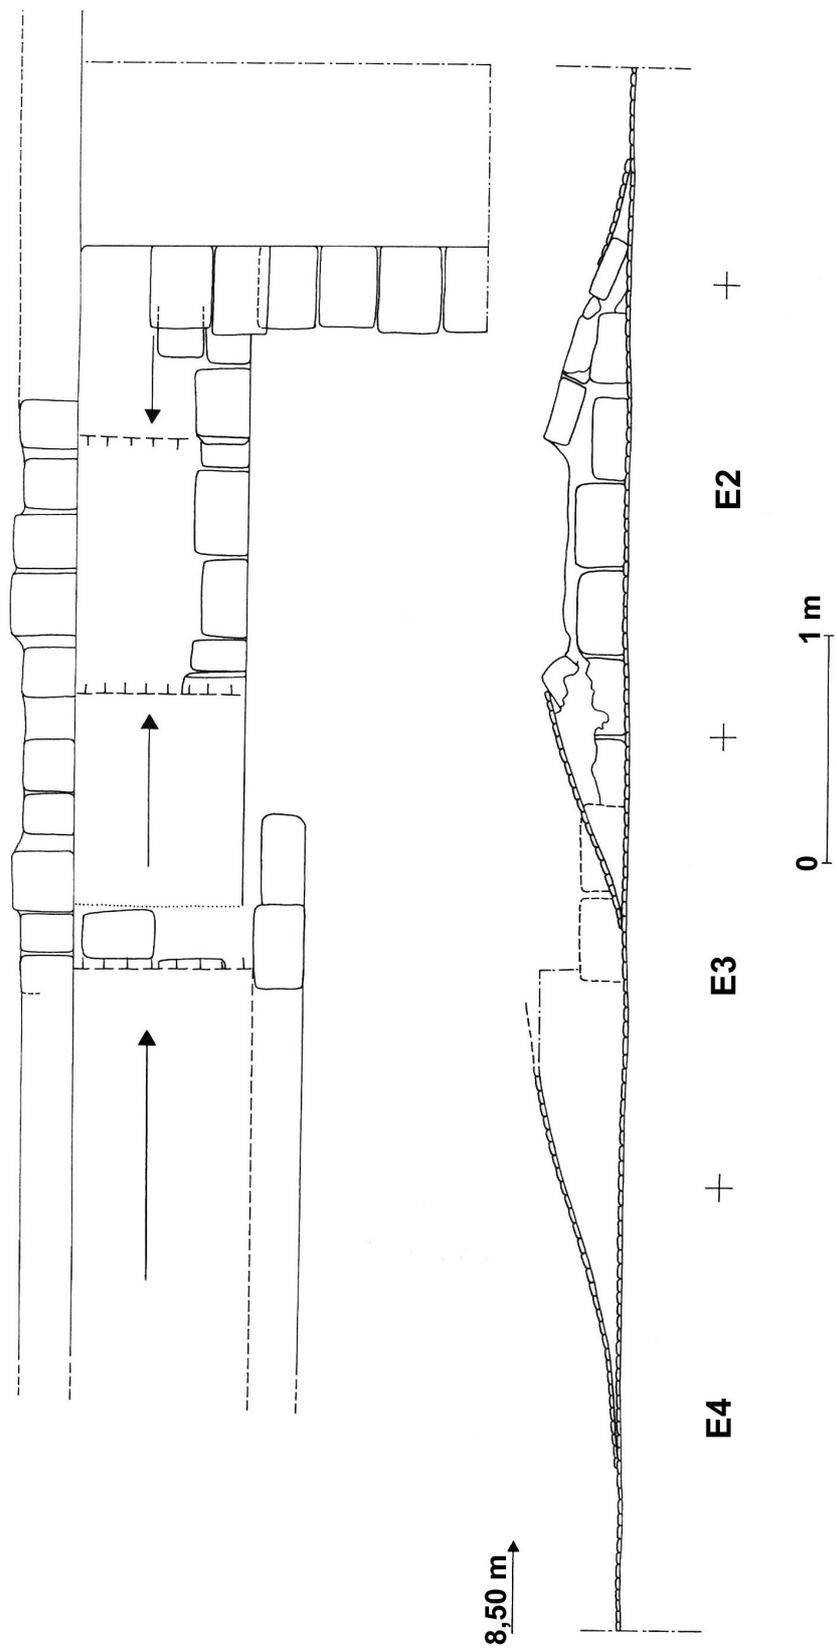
Plano y perfil de las rampas al nivel del piso #3, Terraza Este Bajo
